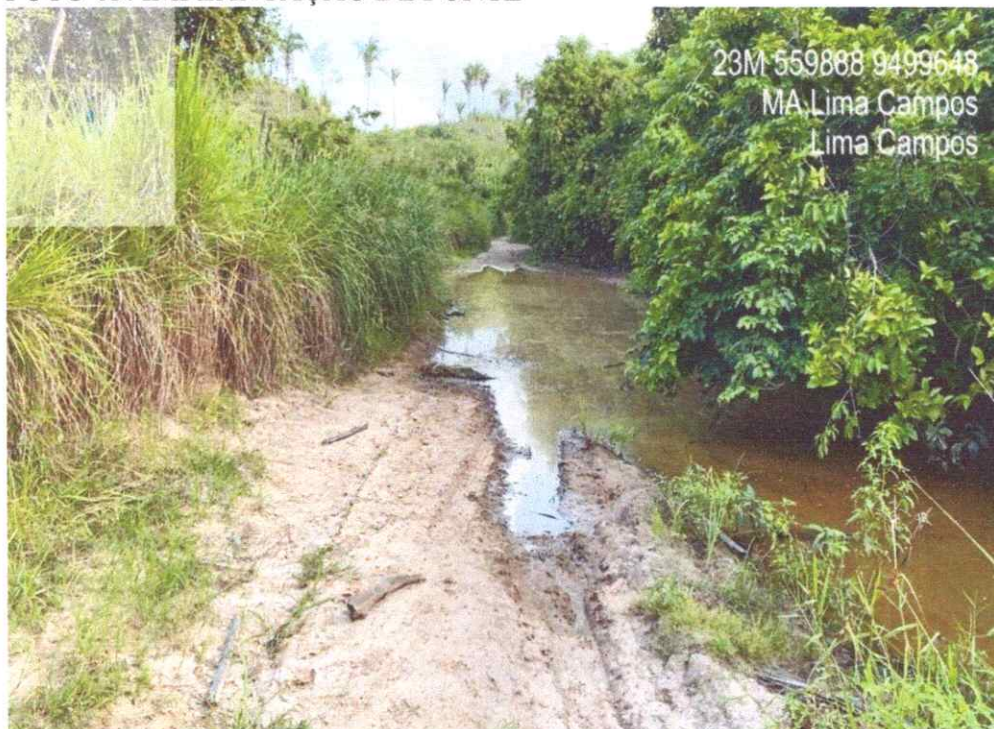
IMPLANTAÇÃO DE BUEIRO
